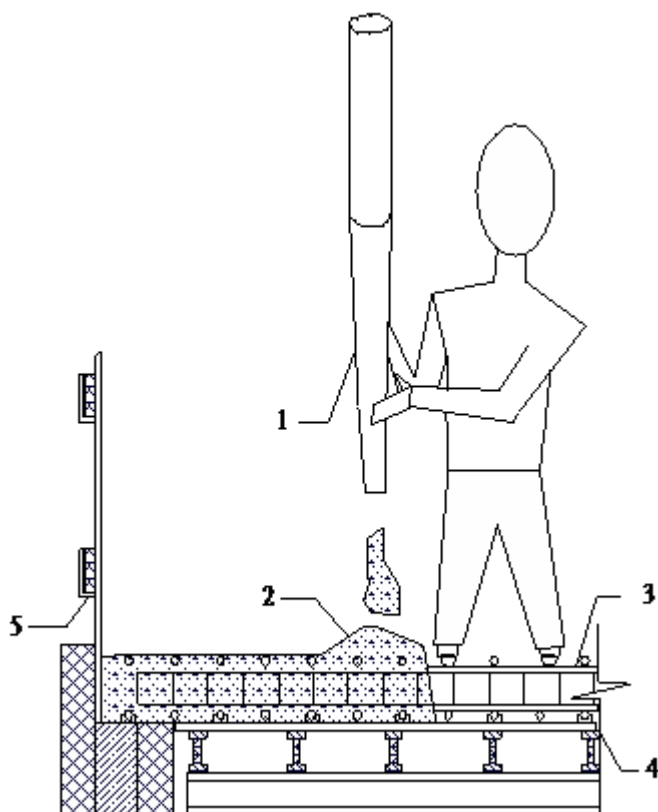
Укладка бетона: 1 –наконечник стрелы автобетононасоса; 2 – укладываемый бетон; 3 арматурная сетка; 4 конструкция опалубки перекрытия; 5 инвентарное ограждение
